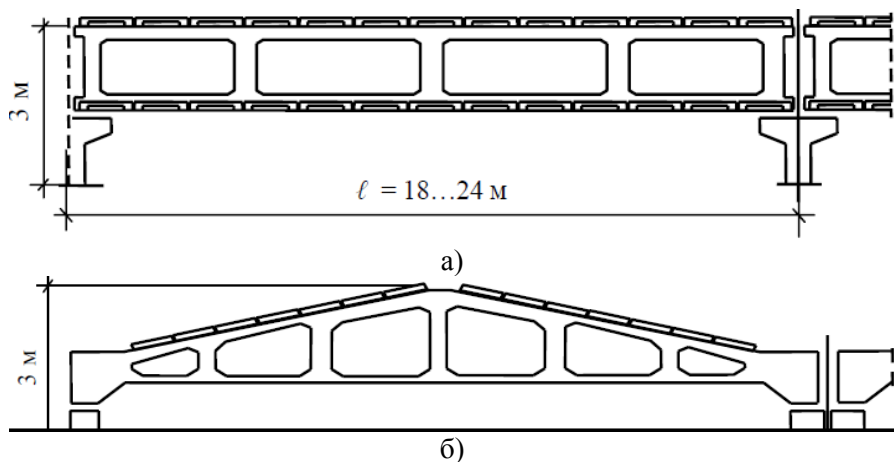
Железобетонные фермы: а – с параллельными поясами; б – арочная
